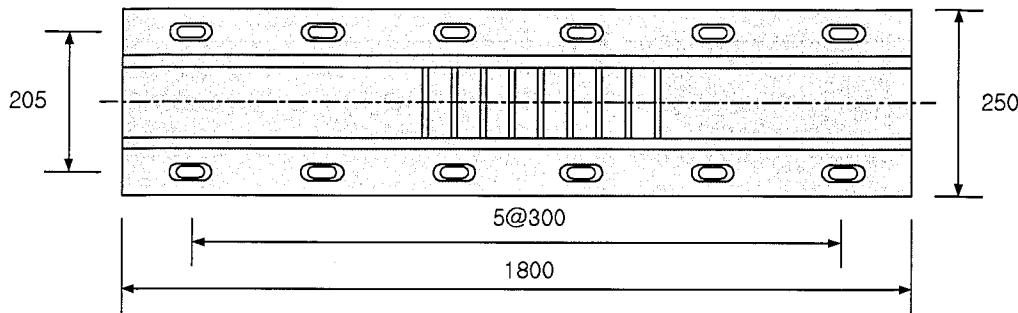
Transflex Joint의 평면도 (단위 : mm)
